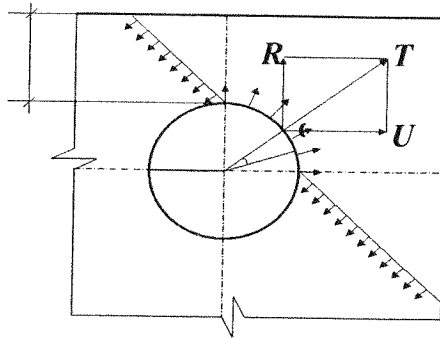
Схема перерізу залізобетонного елемента з кутовою арматурою: R , U – взаємно перпендикулярні складові зусилля T ; T – повне зусилля тиску продуктів корозії на частину, що відривається; t_k – тиск продуктів корозії на бетон захисного шару кутової арматури; r – радіус арматури; a – захисний шар бетону; R_{bt} – розрахунковий опір бетону відриву (осьовому розтягу).
